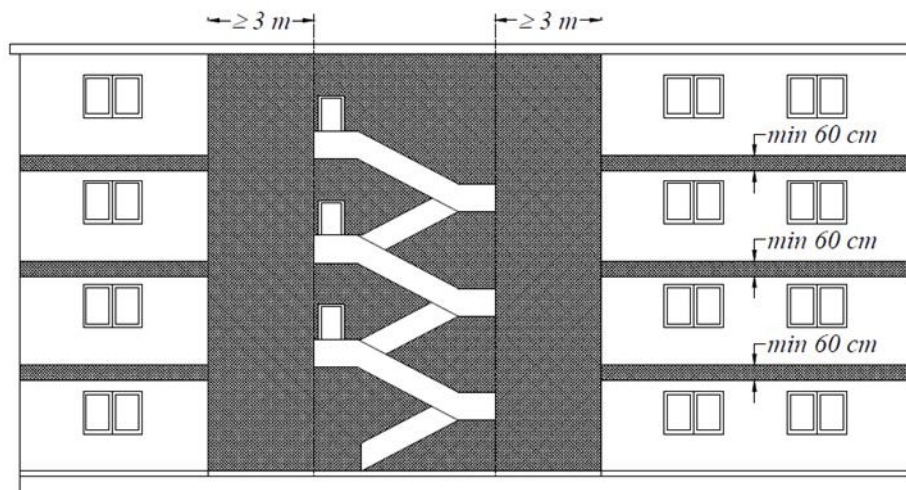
Решение для наружных лестниц по ограничению распространения пожара по фасаду
